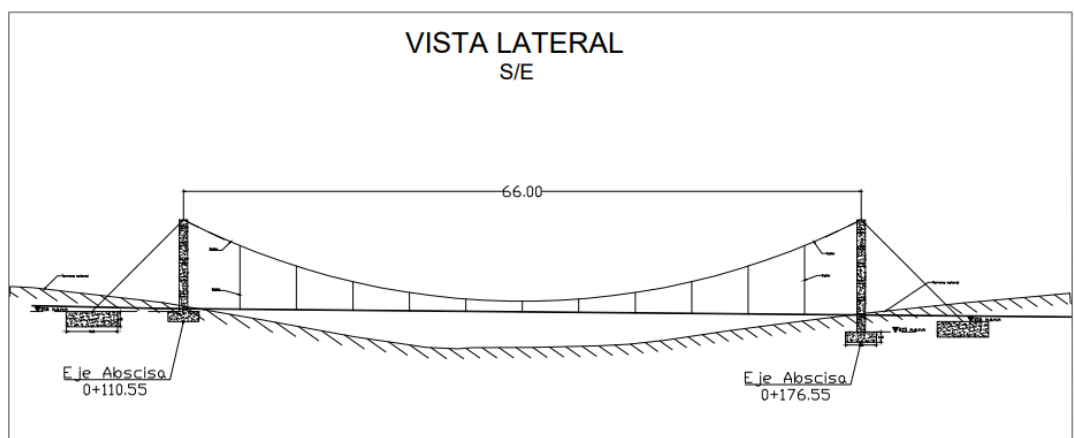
Vista lateral de puente elevado para tubería en tramo 0+110.55 a 0+176.55.
